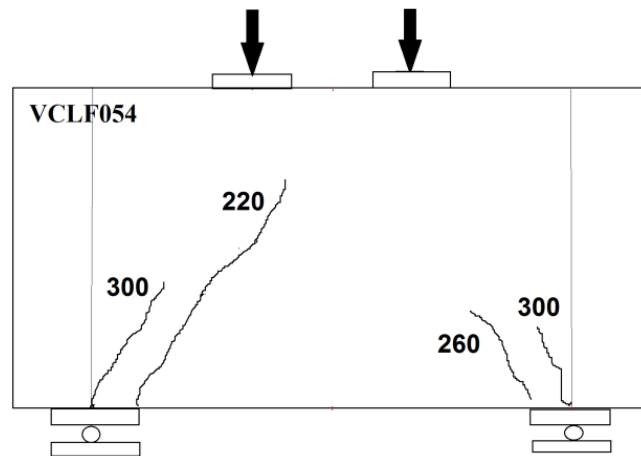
Esquema de fissuração da viga VCLF054.
